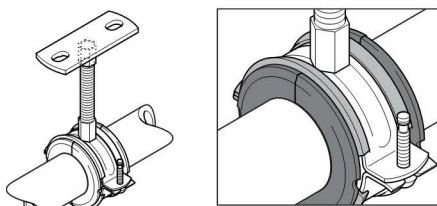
Rohrschelle mit Schalldämmeinlage und Einlegeschale
